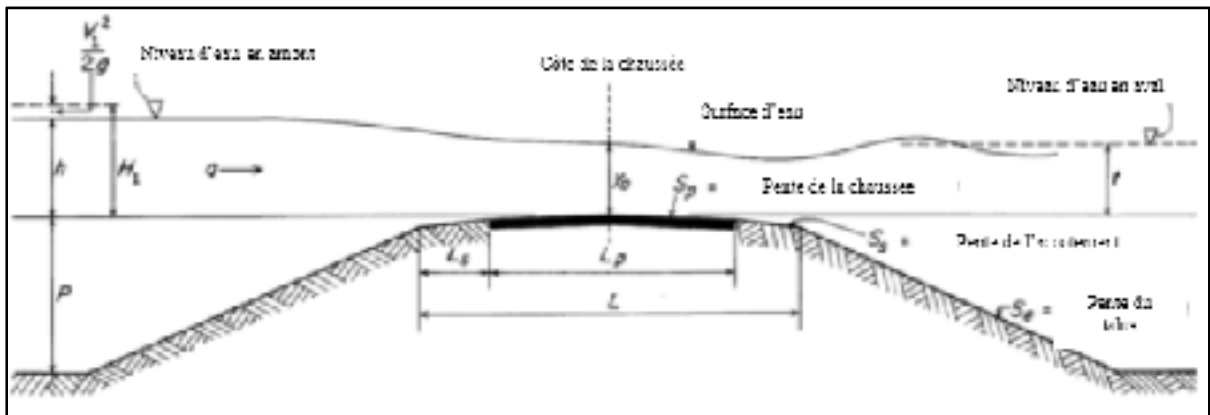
Principaux paramètres géométriques et hydrauliques gérant le comportement de l'eau sur une chaussée
